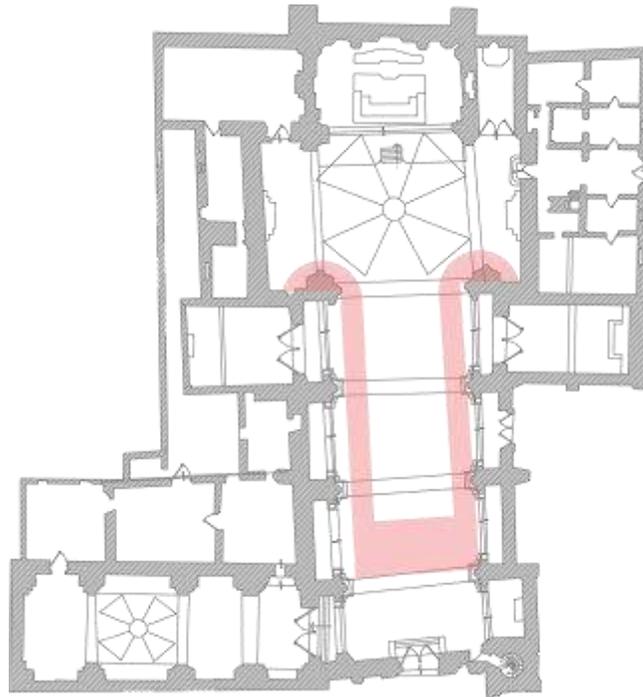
Propuesta inicial de diseño para la estructura de intervención al interior de la nave
